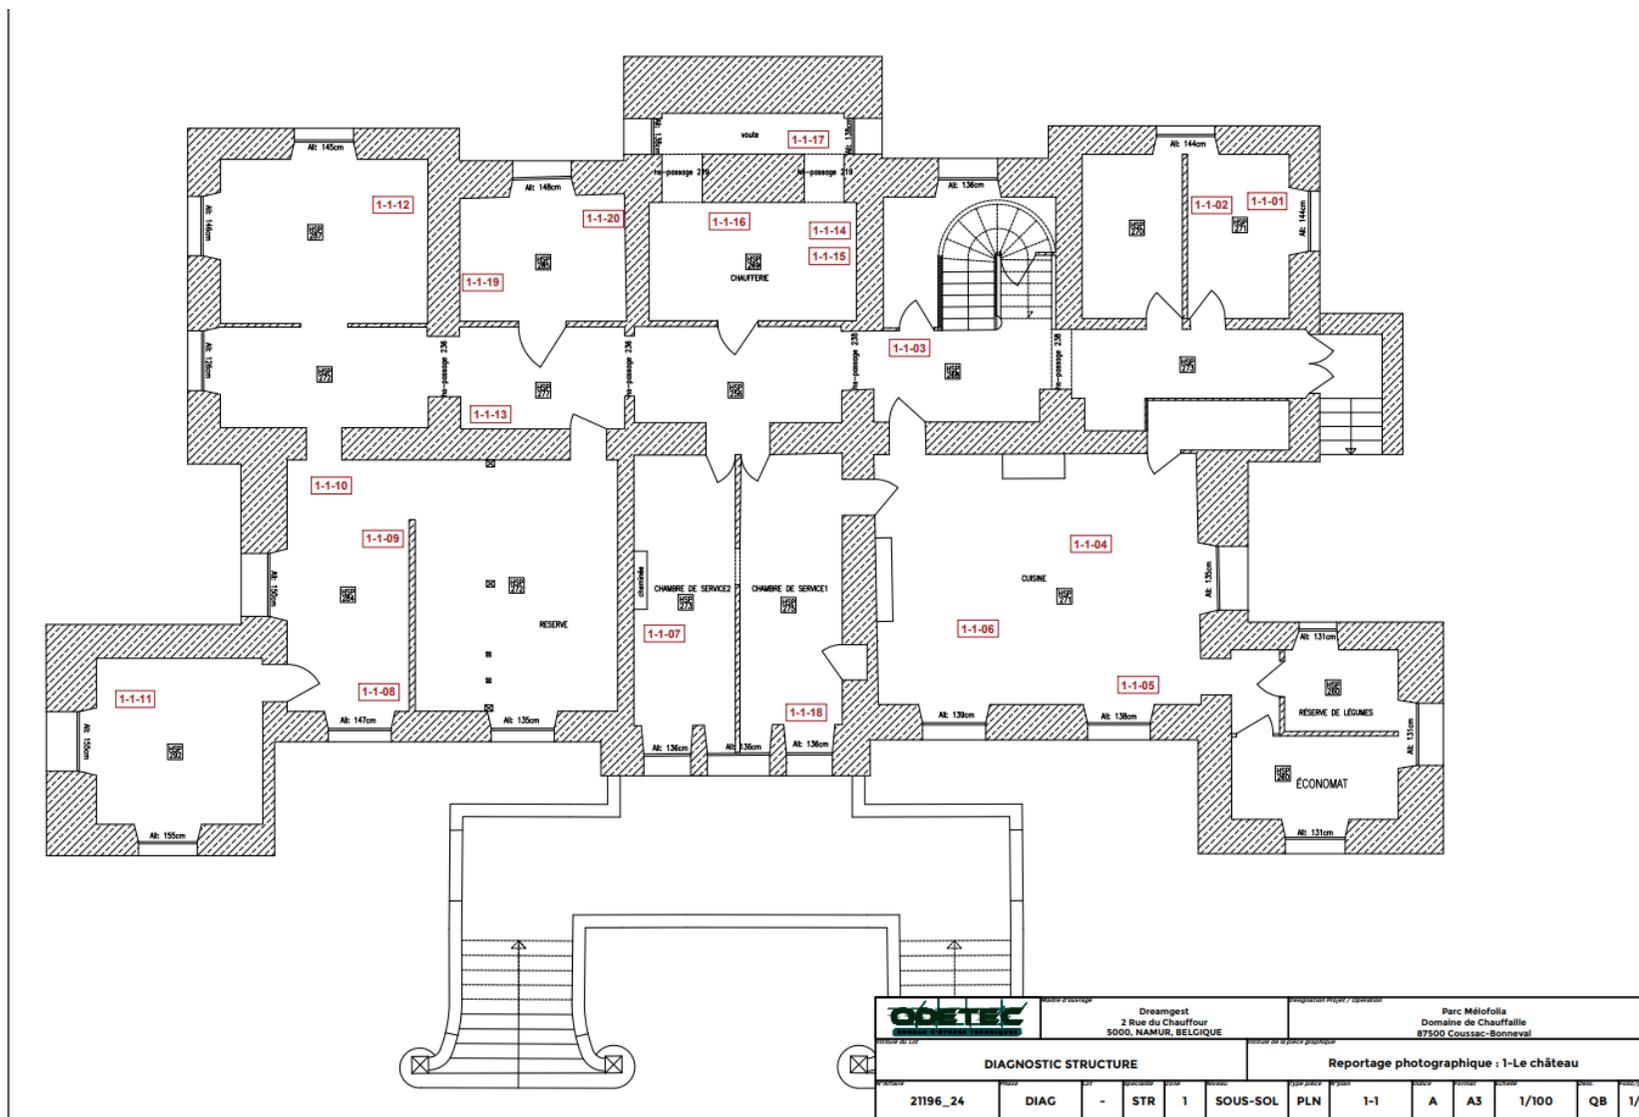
Plan du château (rez-de-chaussée) (Source : ODETEC, mai 2023)
